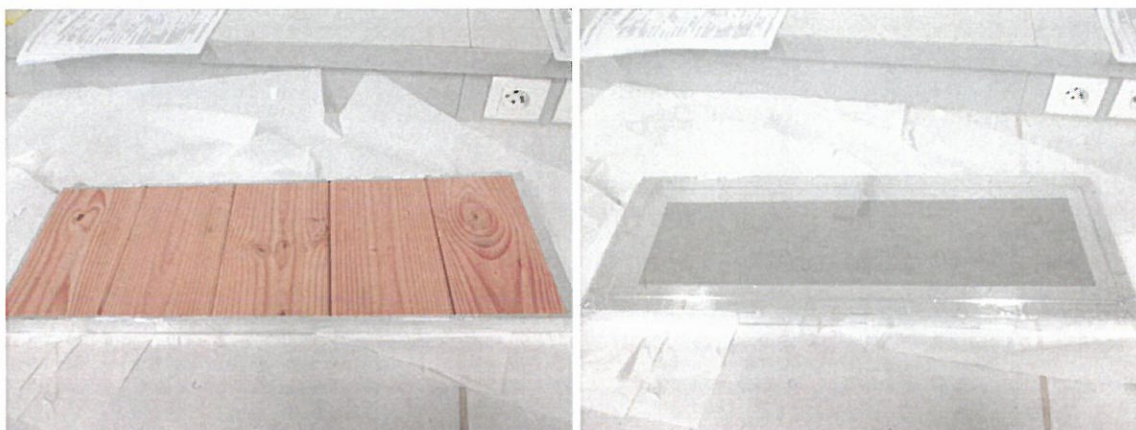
Eprouvette d'essai 14/1216C/4 après découpe et colmatage
